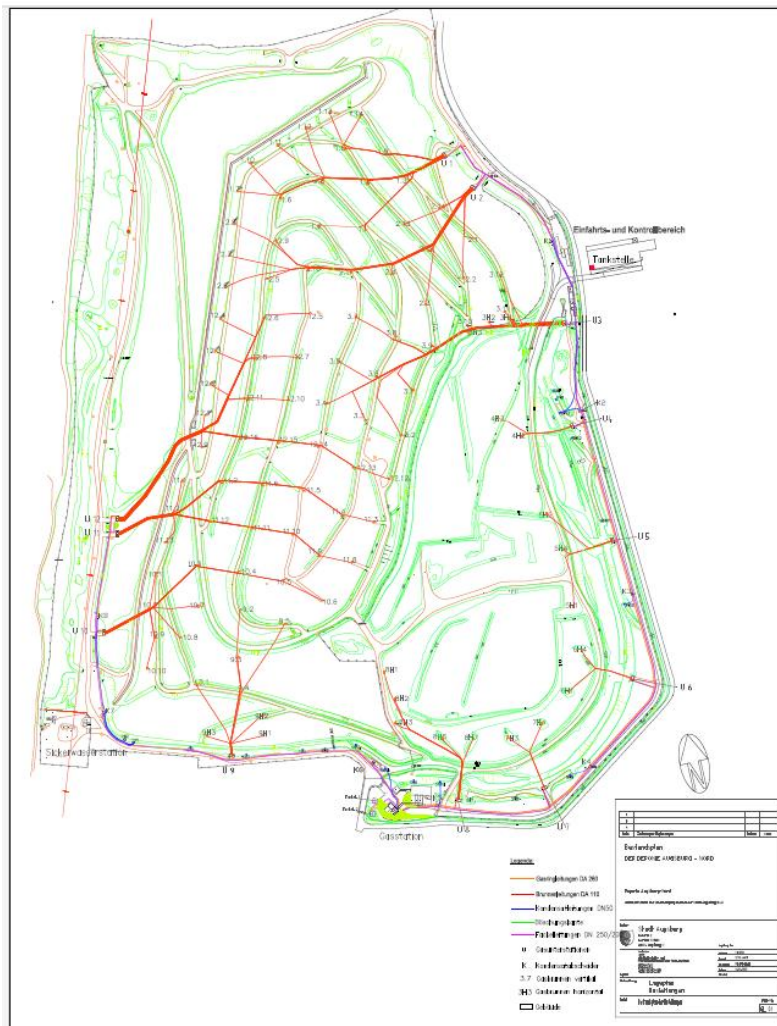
Lageplan Deponiegaseinrichtungen Bestand 2002
